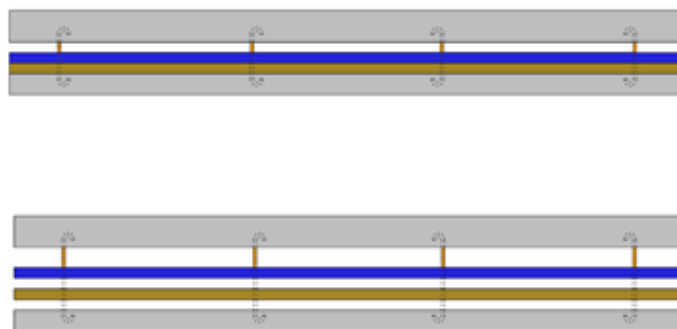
Esquemas de ligação dos materiais constituintes dos painéis pré-fabricado em corte
